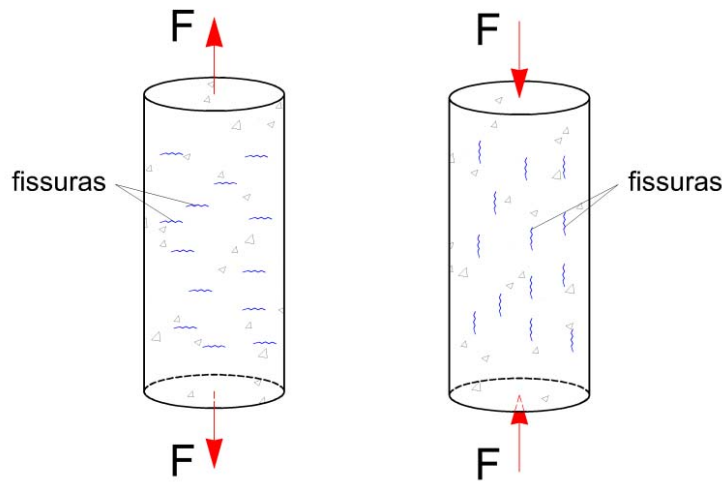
Panorama da fissuração no concreto à tração e à compressão respectivamente
